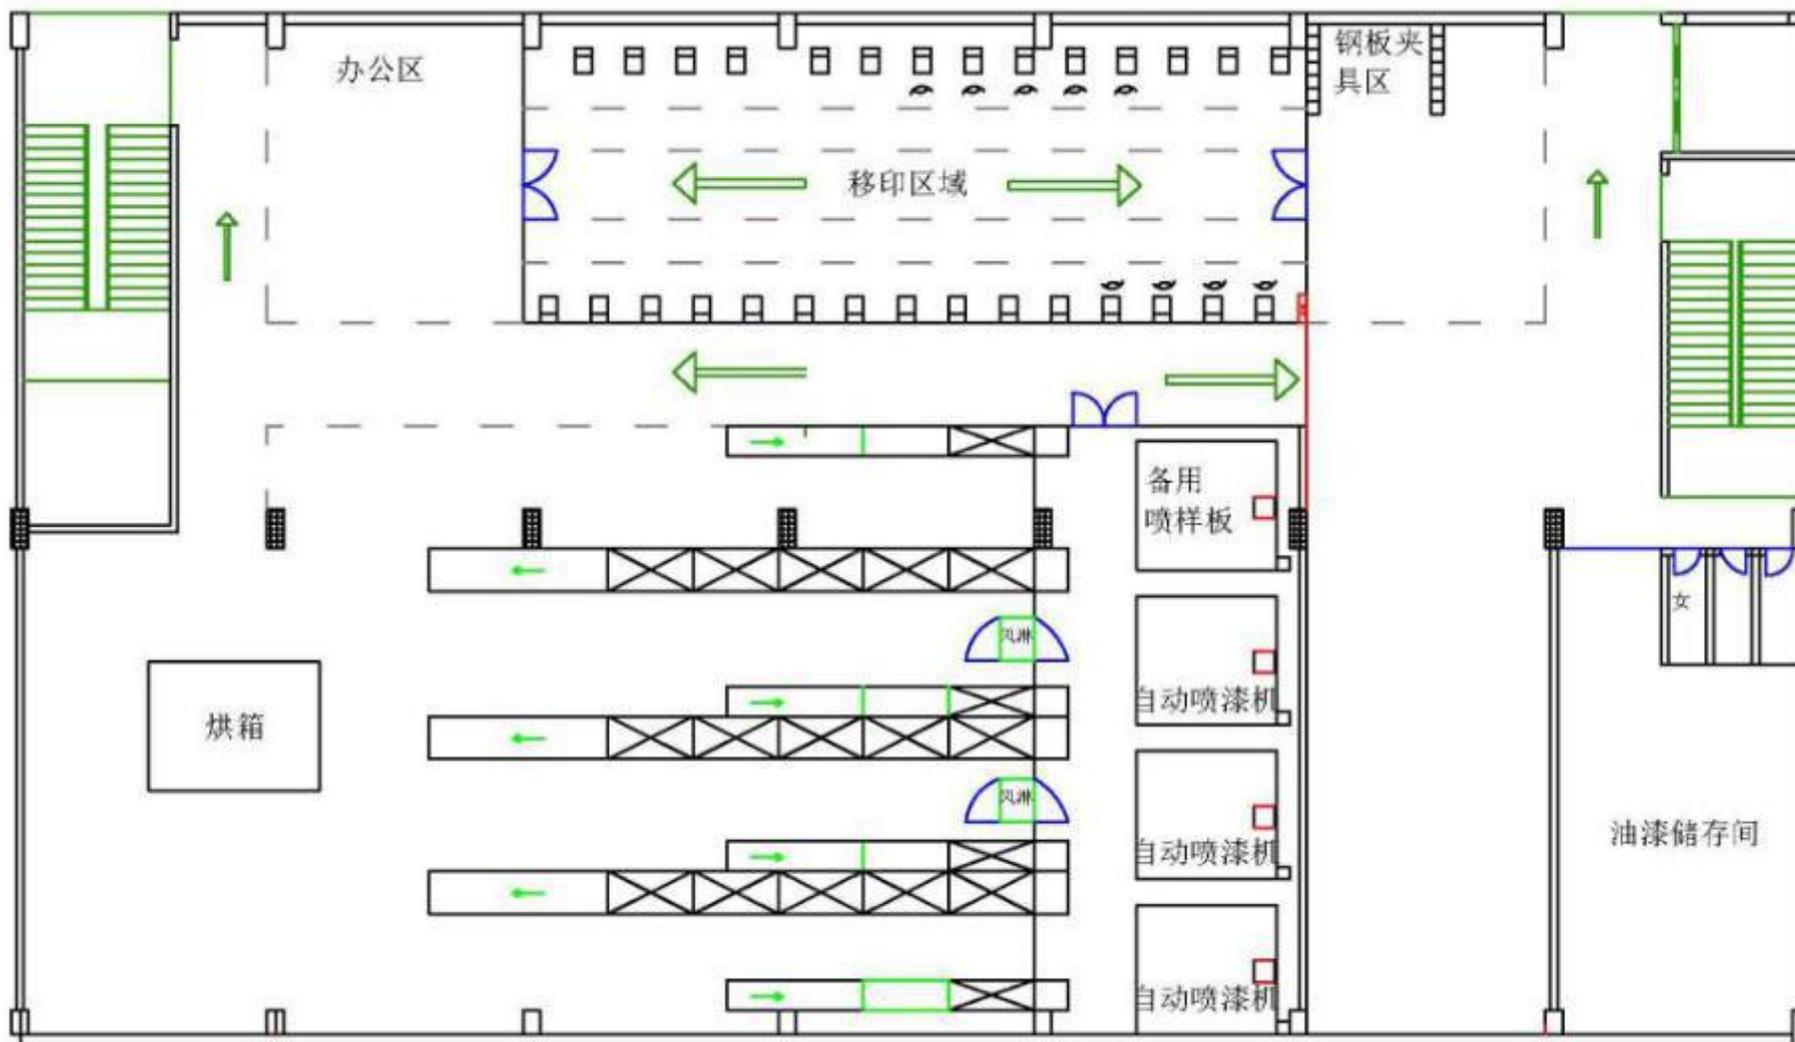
厂房平面布置图（喷油车间，E 栋六层，新增）
